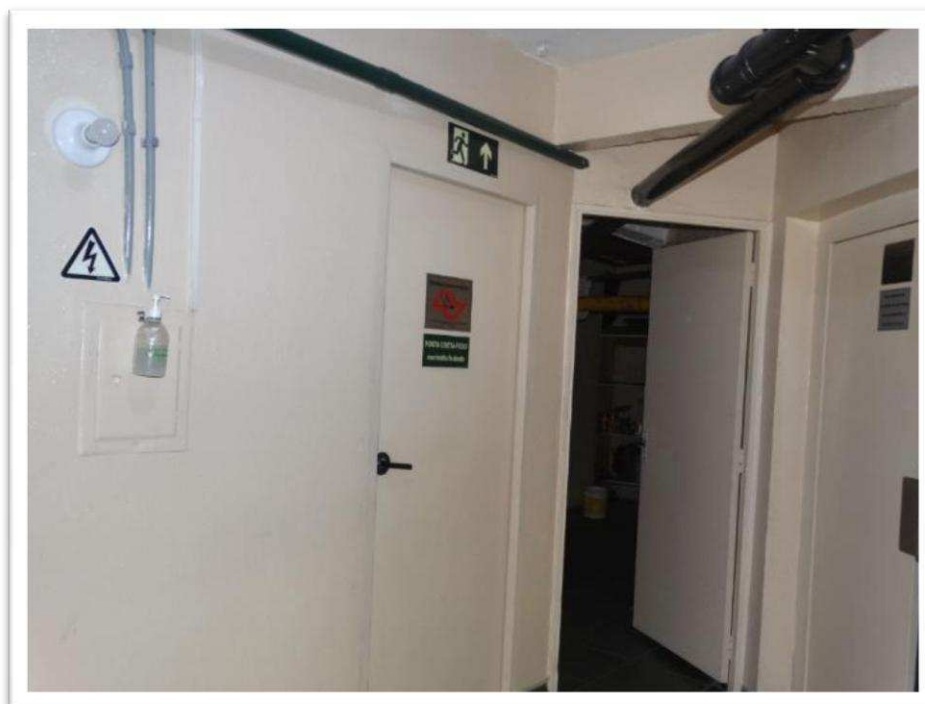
Vista parcial interna do Edifício Via Colomba – Hall dos Elevadores no 1º subsolo.
